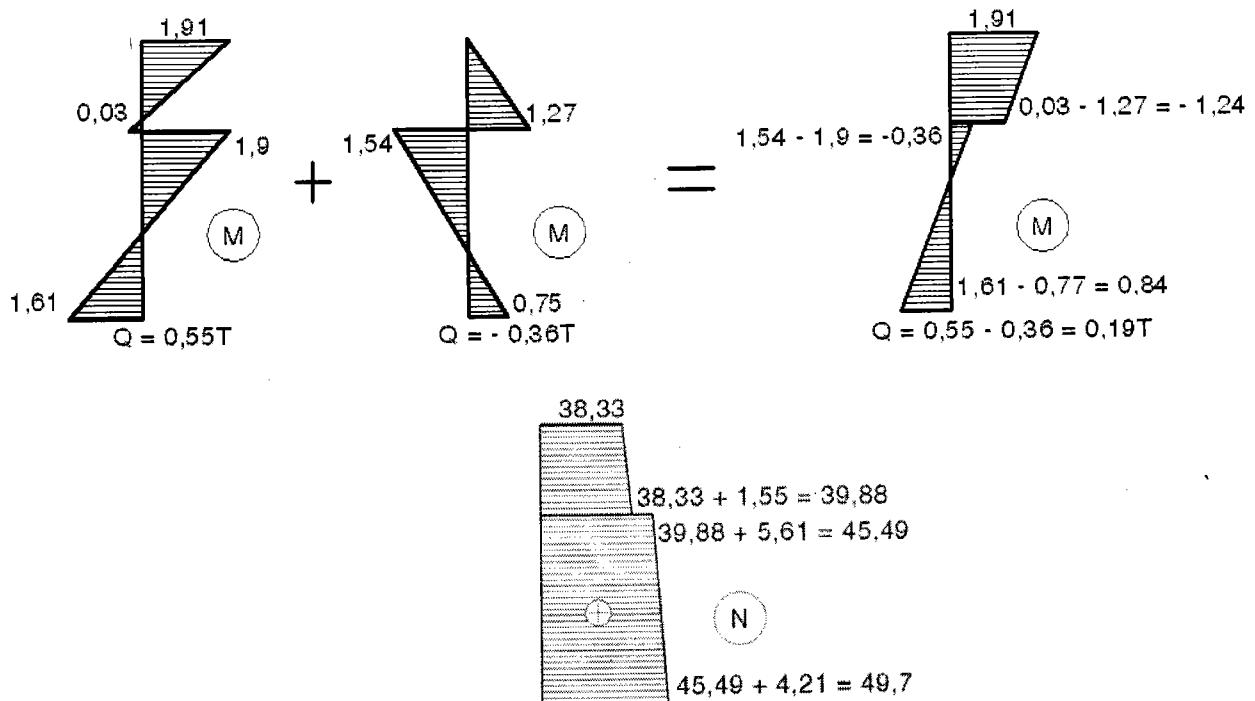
Sơ đồ tĩnh cột giữa do tĩnh tải dầm
